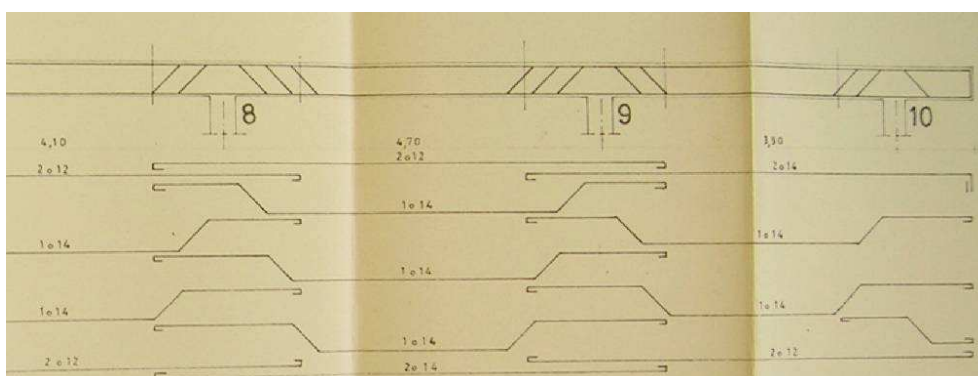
Despiece de armado de vigas, Edificio ficha 186ª.009, 1968.
